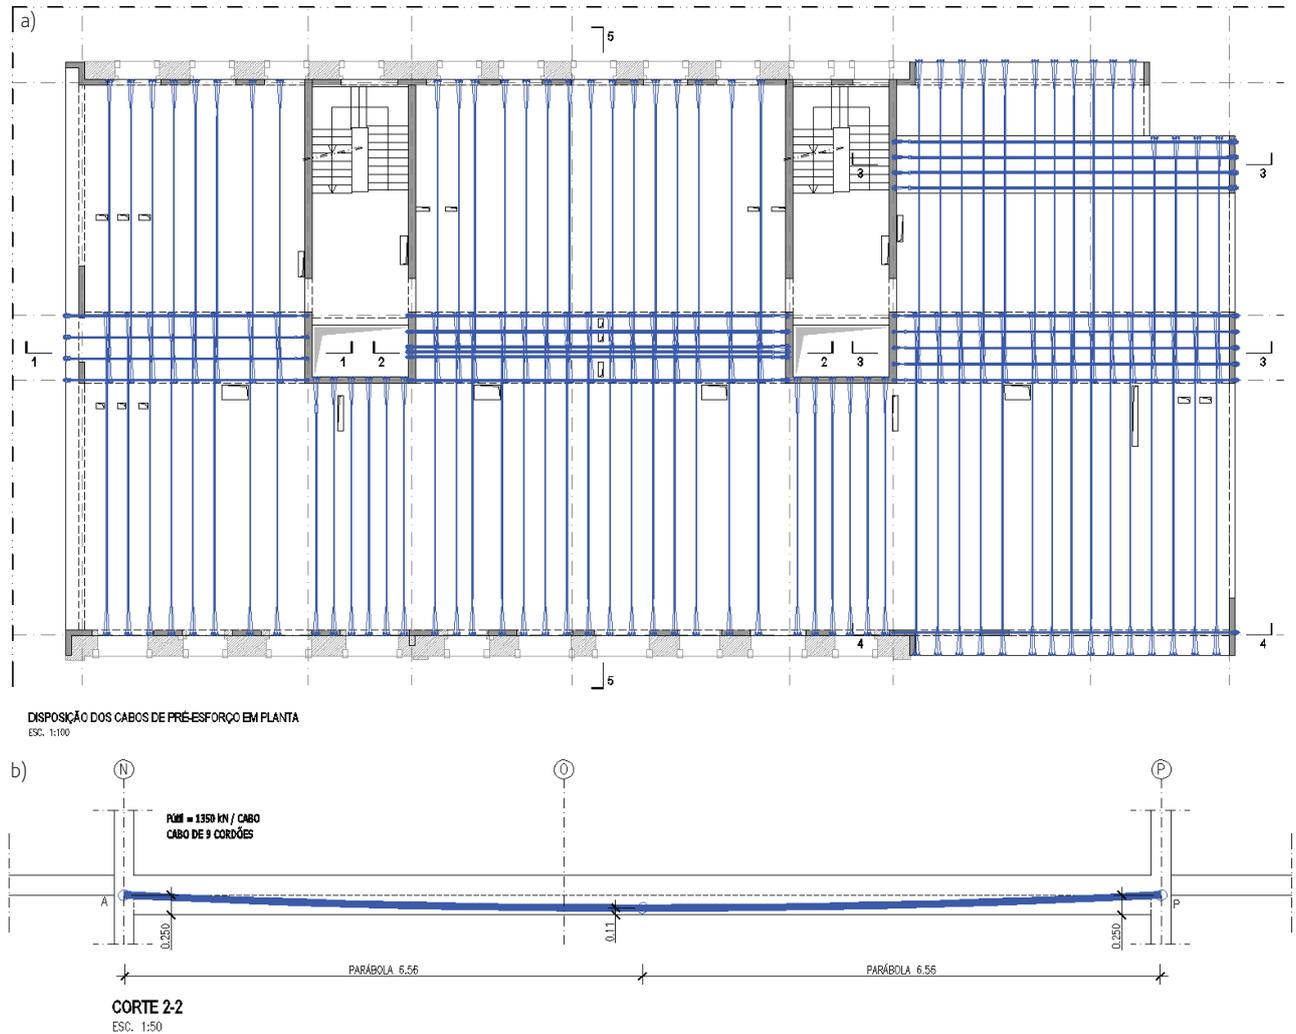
Pré-esforço nas lajes dos pisos elevados. a) Distribuição em planta; b) Corte longitudinal (zona entre núcleos)
